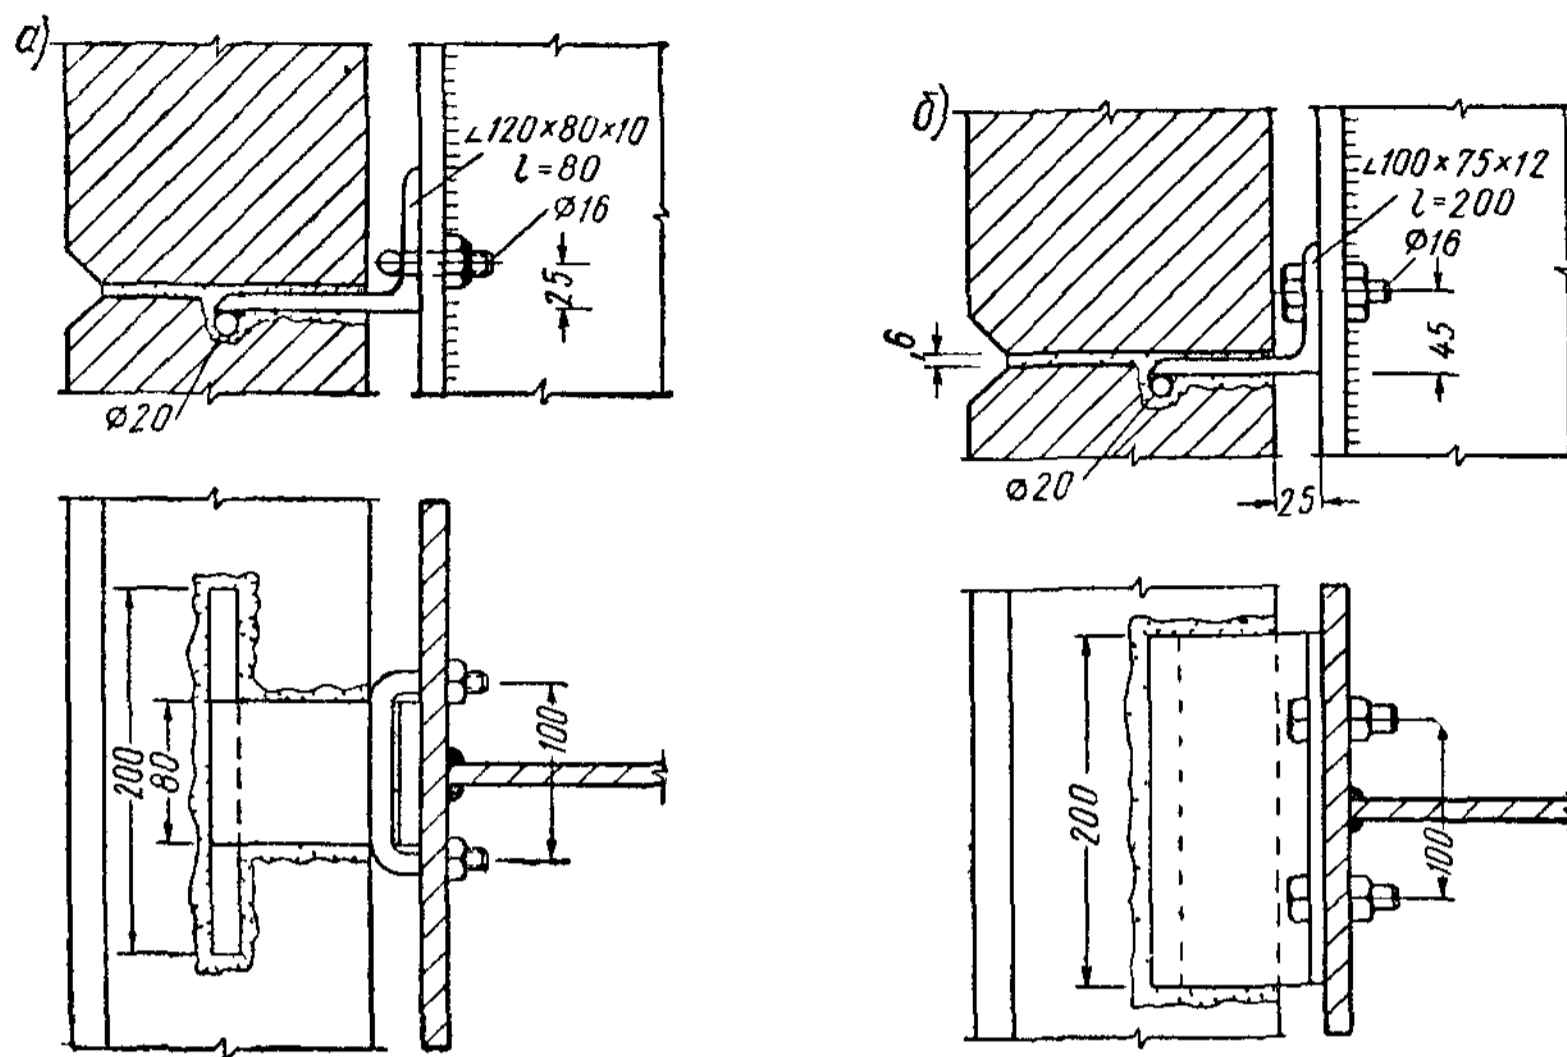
Прикрепление армопенобетонных панелей к колоннам
